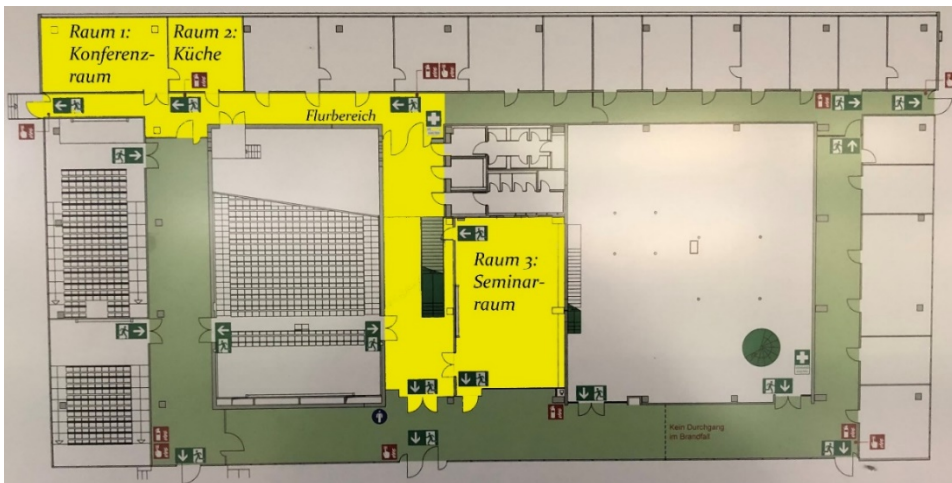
Versuchsgebäude 1: Grundriss und Untersuchungsbereich⁶⁴
